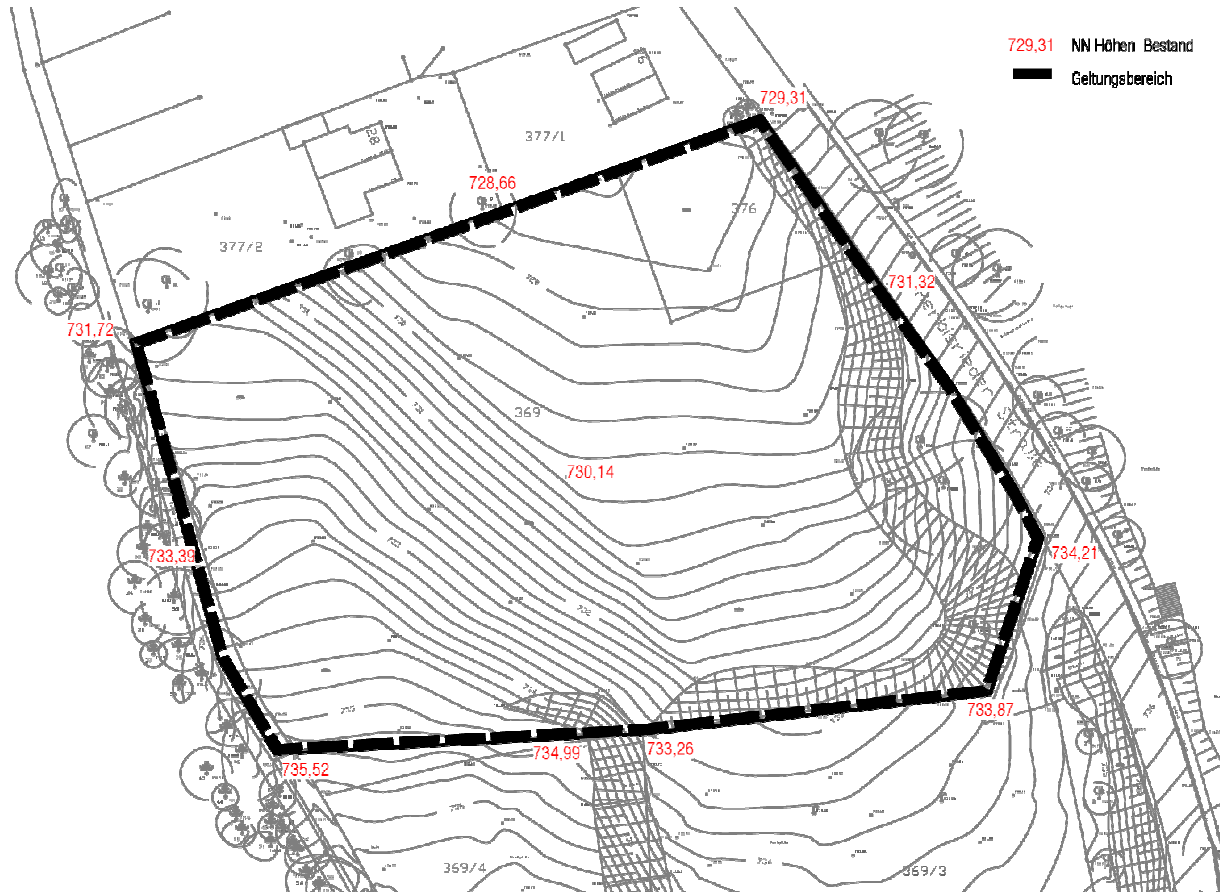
Plangrundlage aiv GmbH, Angewandte Ingenieur-Vermessung v. 26.02.2021 maßstabslos, genordet
